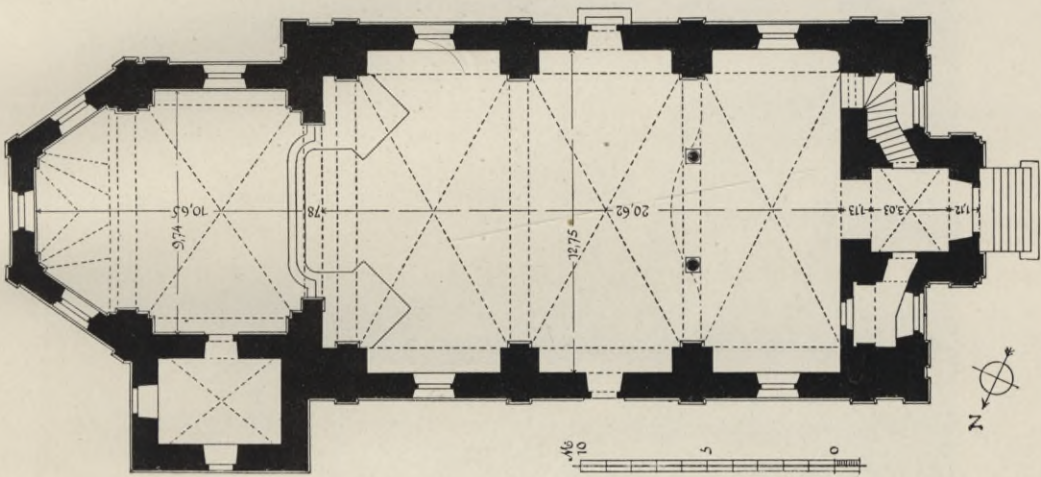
Retzbach. Grundriß der Pfarrkirche.
